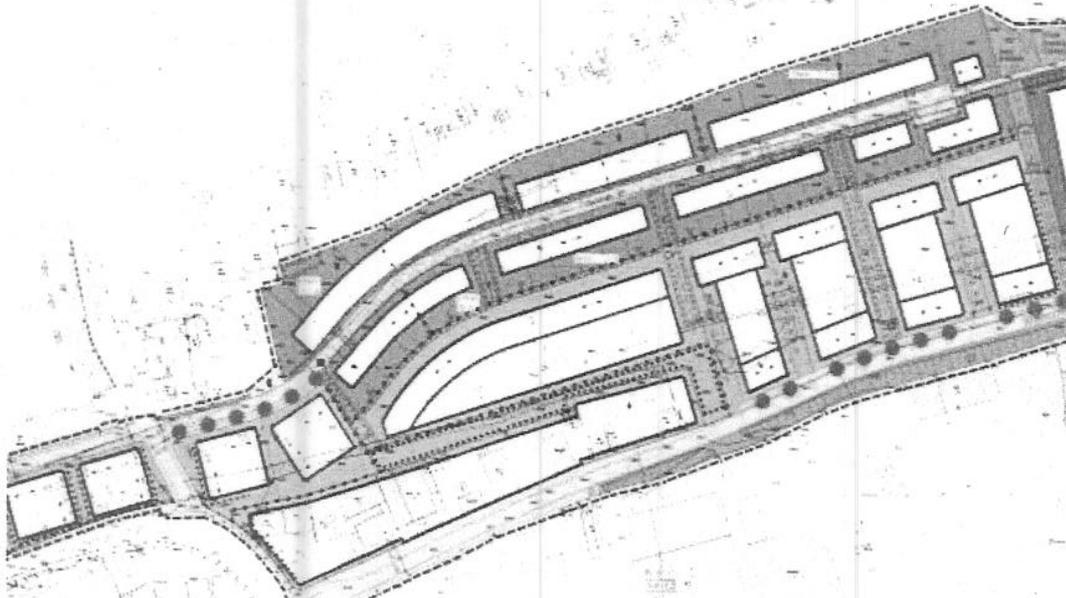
Planausschnitt Bebauungsplan Nr. 66
